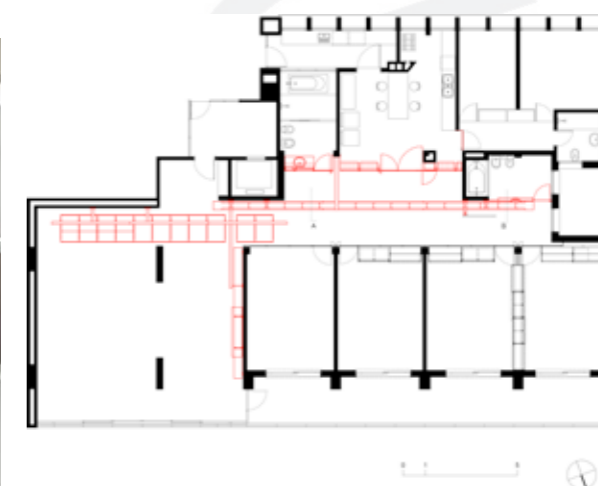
e Imagem 4 - planta. Reforma Prudência Andrade Morettin. © Nelson Kon
